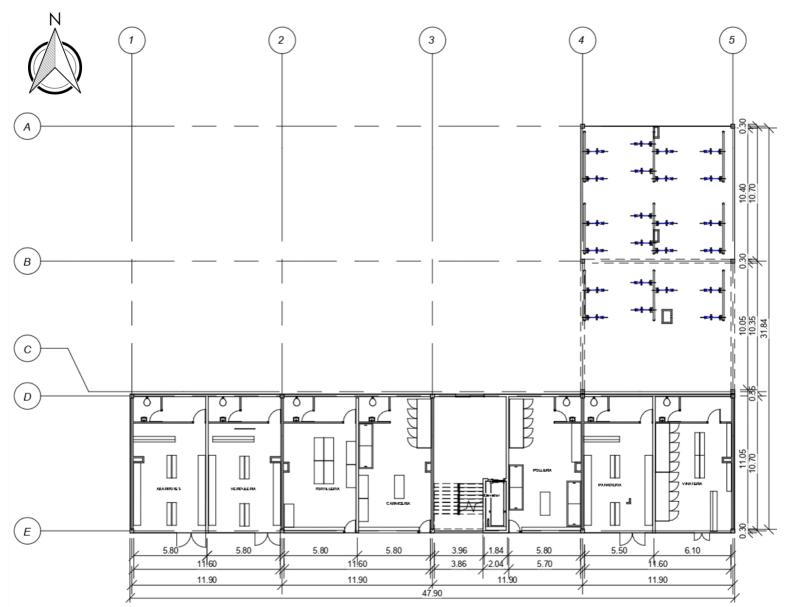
Propuesta final. Planta baja. Elaboración propia. 2022
